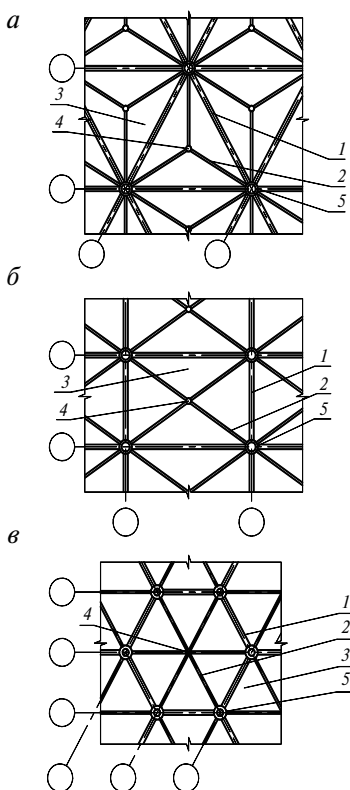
Перекрытие с контурными и диагональными ригелями при: *а* – треугольных, *б* – прямоугольных, *в* – шестиугольных ячеекх.
